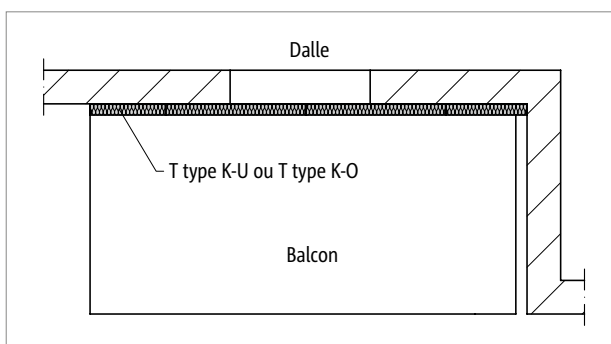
Schöck Isokorb® T types K-U/K-O : balcon dans le cas d'un décrochement de façade
